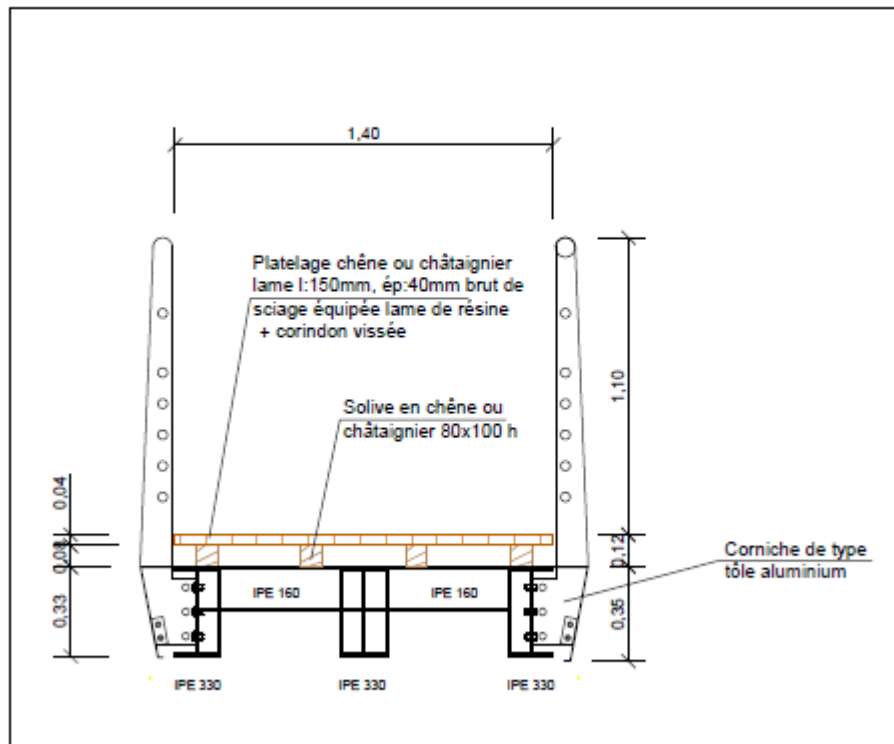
Ouvrage de la pointe du Château : coupe longitudinale (source : Atelier Nāga)
